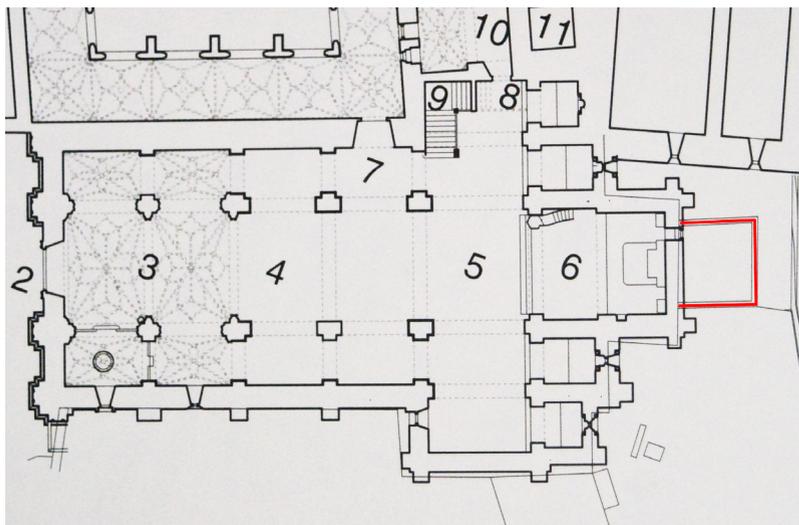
Santa Maria De Melon, Alzado Norte, cubierta cabecera, girola.
